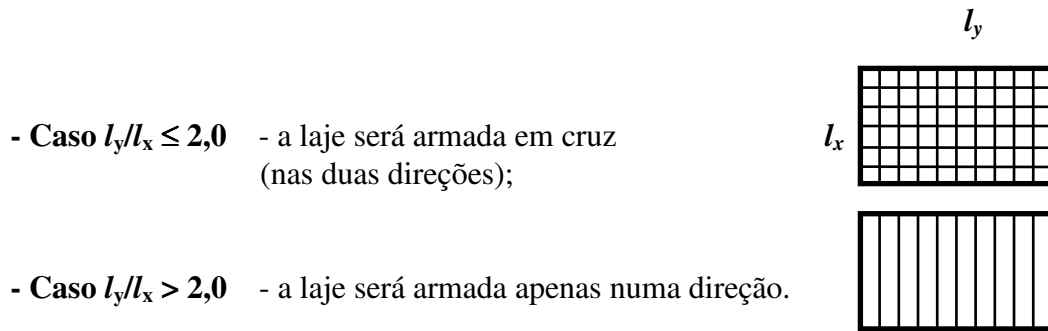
Lajes armadas em cruz e em apenas uma direção
